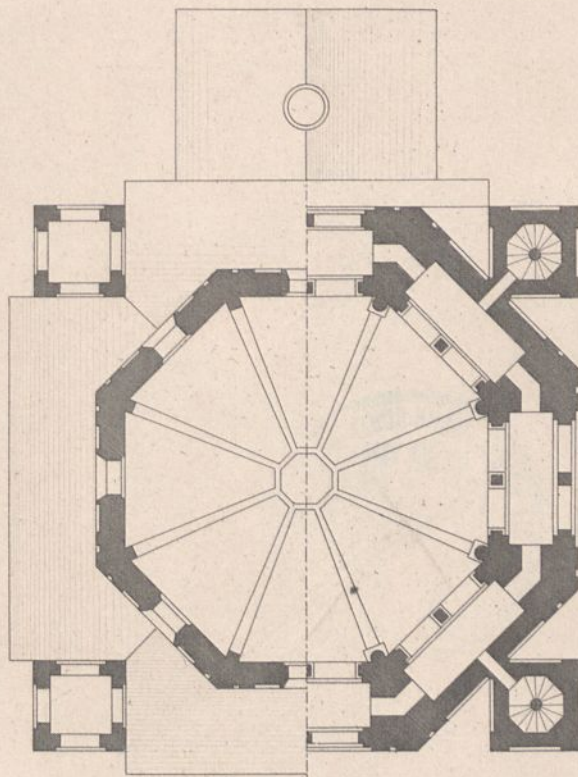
Grundriss n. CD (Bl. 38 Fig. 2)
